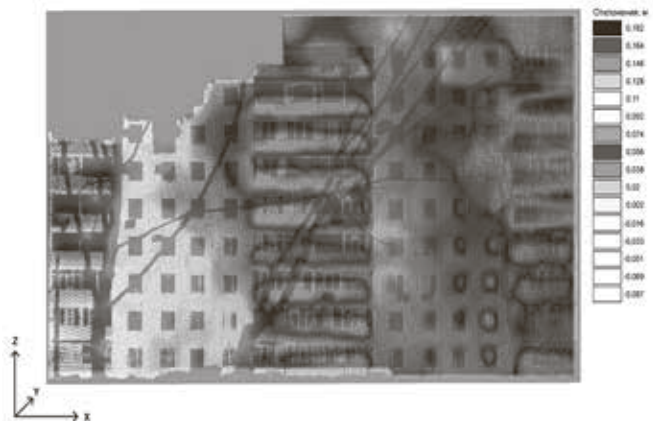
Модель главного фасада девятиэтажного дома с нанесенным градиентом отклонения панелей от вертикали /
